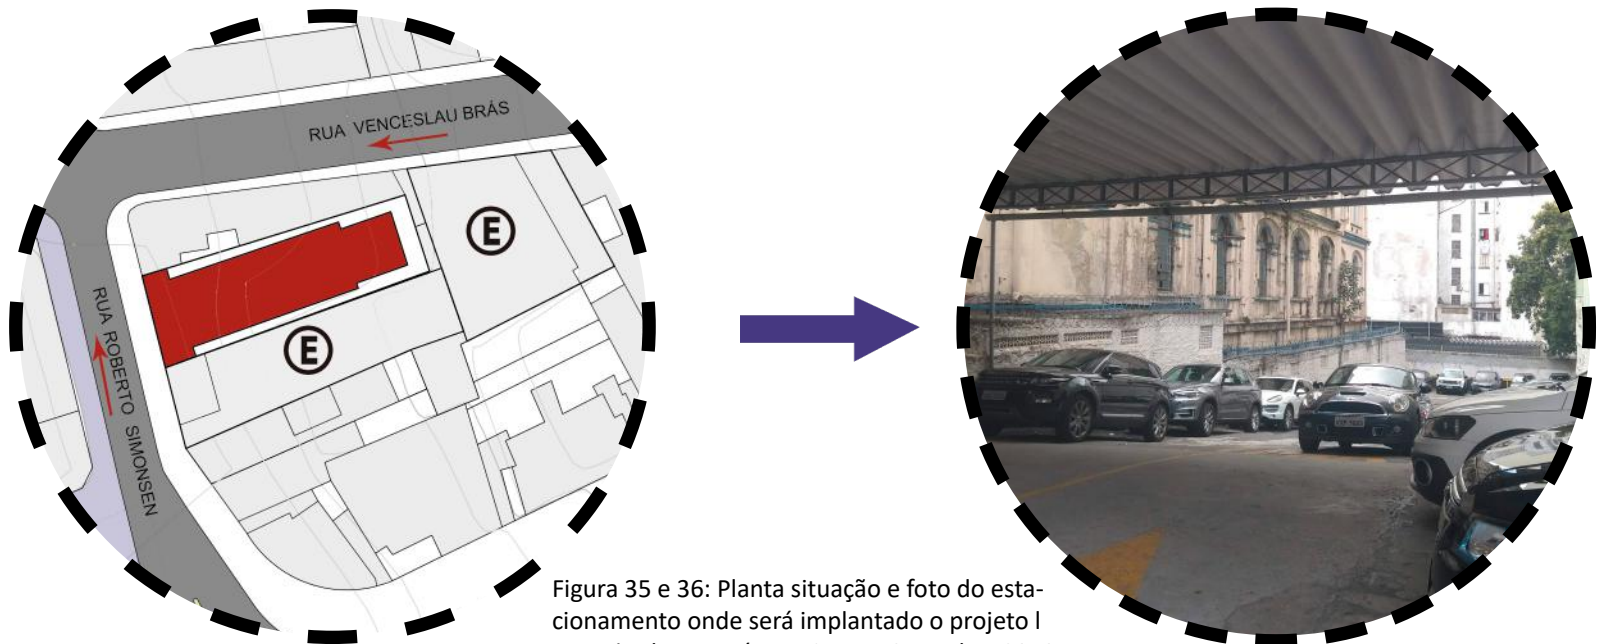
e 36: Planta situação e foto do estacionamento onde será implantado o projeto I
